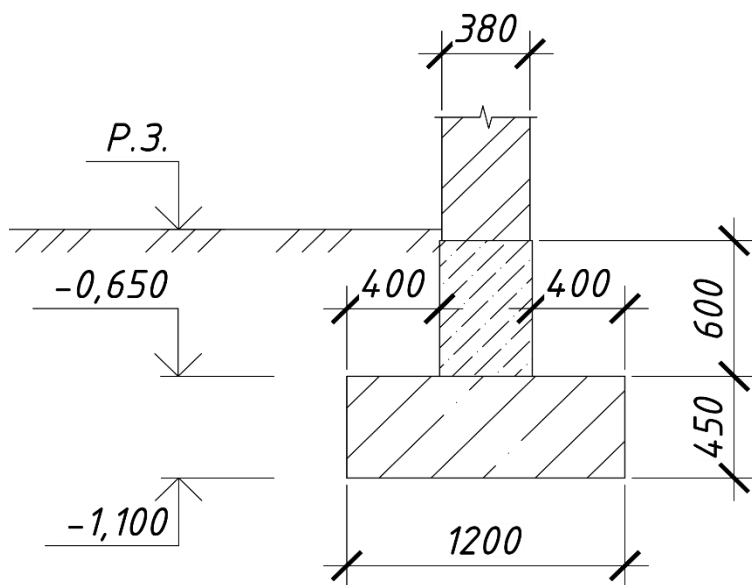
Розріз фундаменту згідно протоколу випробувань
